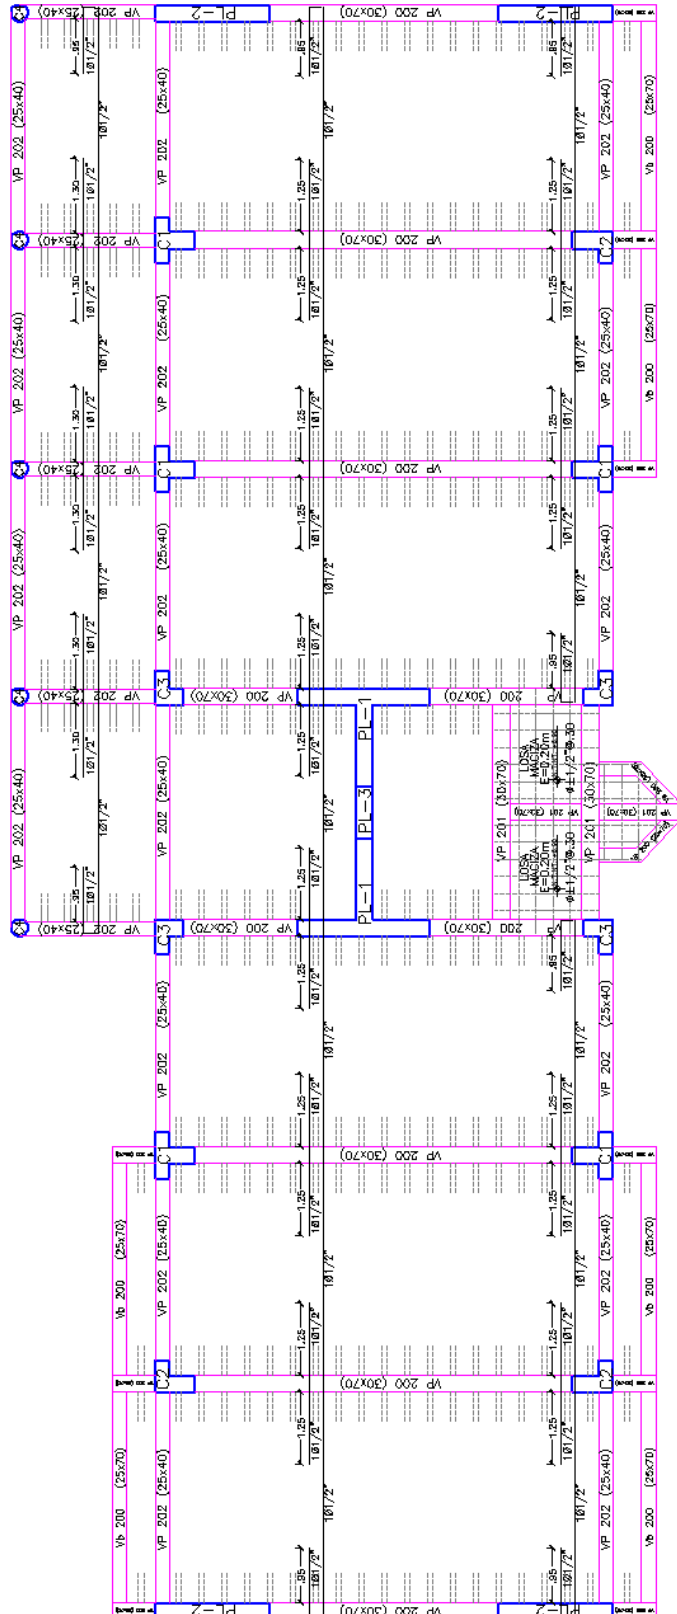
Planta, aligerado 2, NTNT: +6.90.
